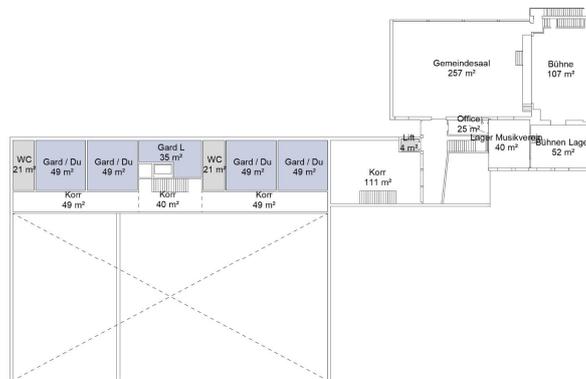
1. Obergeschoss Turnhalle, Variante «violett»
